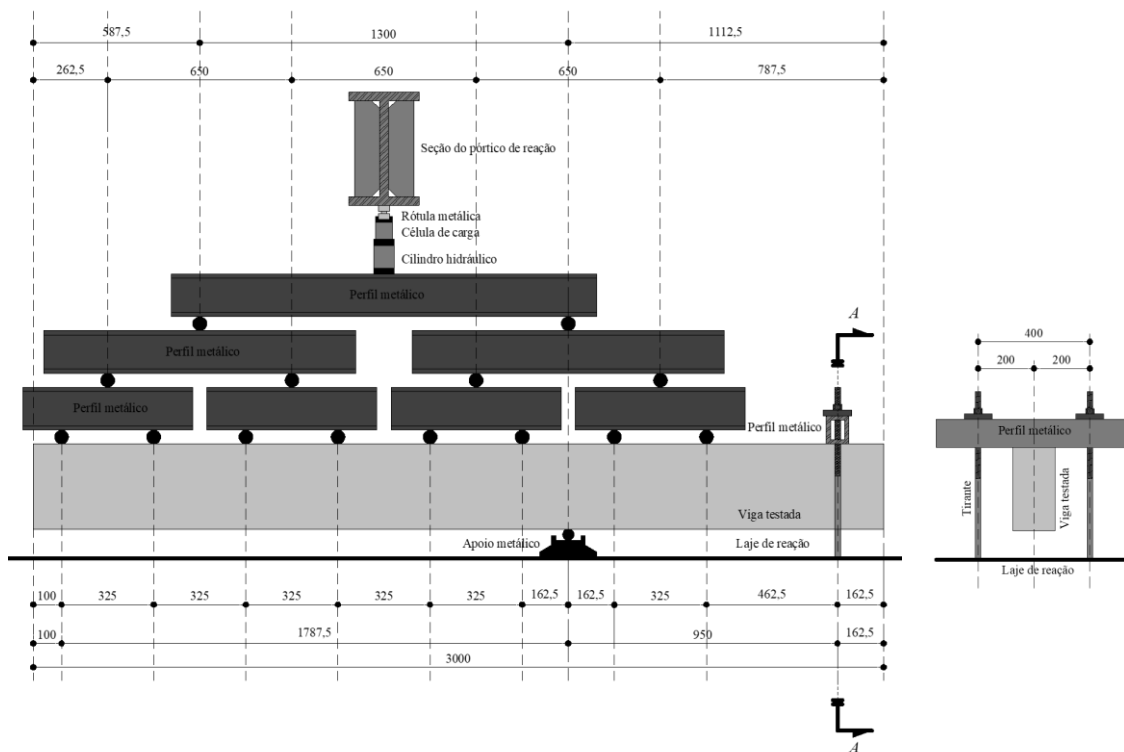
Esquema do plano de instrumentação (cotas em mm).
